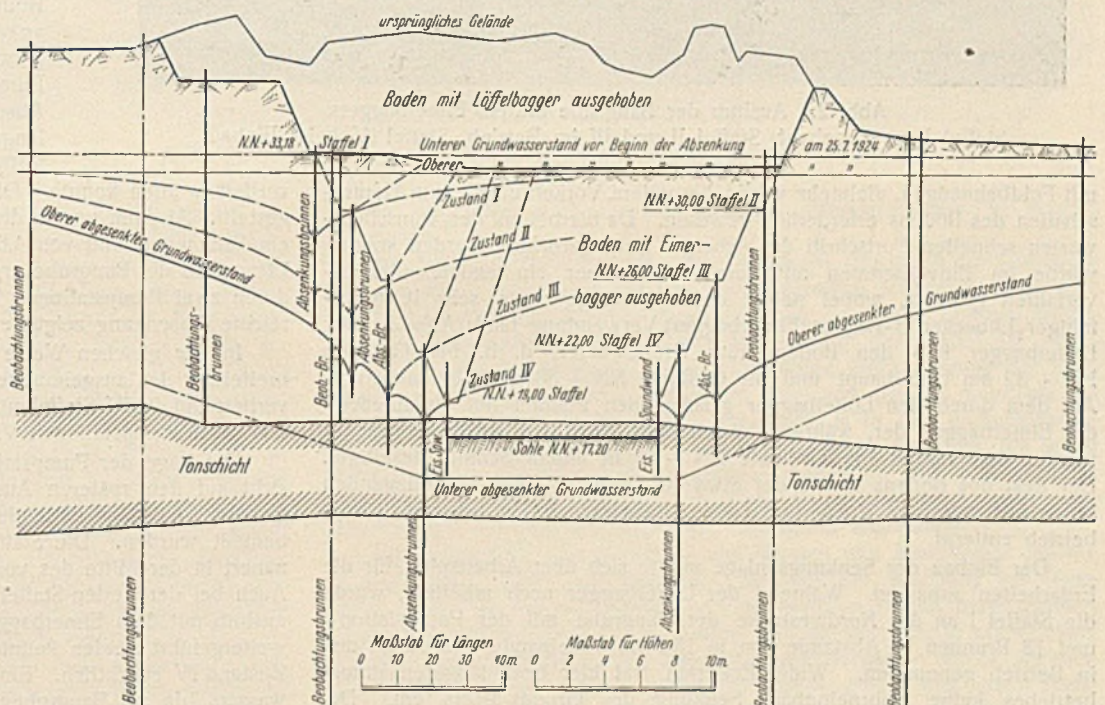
Schnitt durch die Baugrube mit Darstellung der Grundwasserabsenkung.
